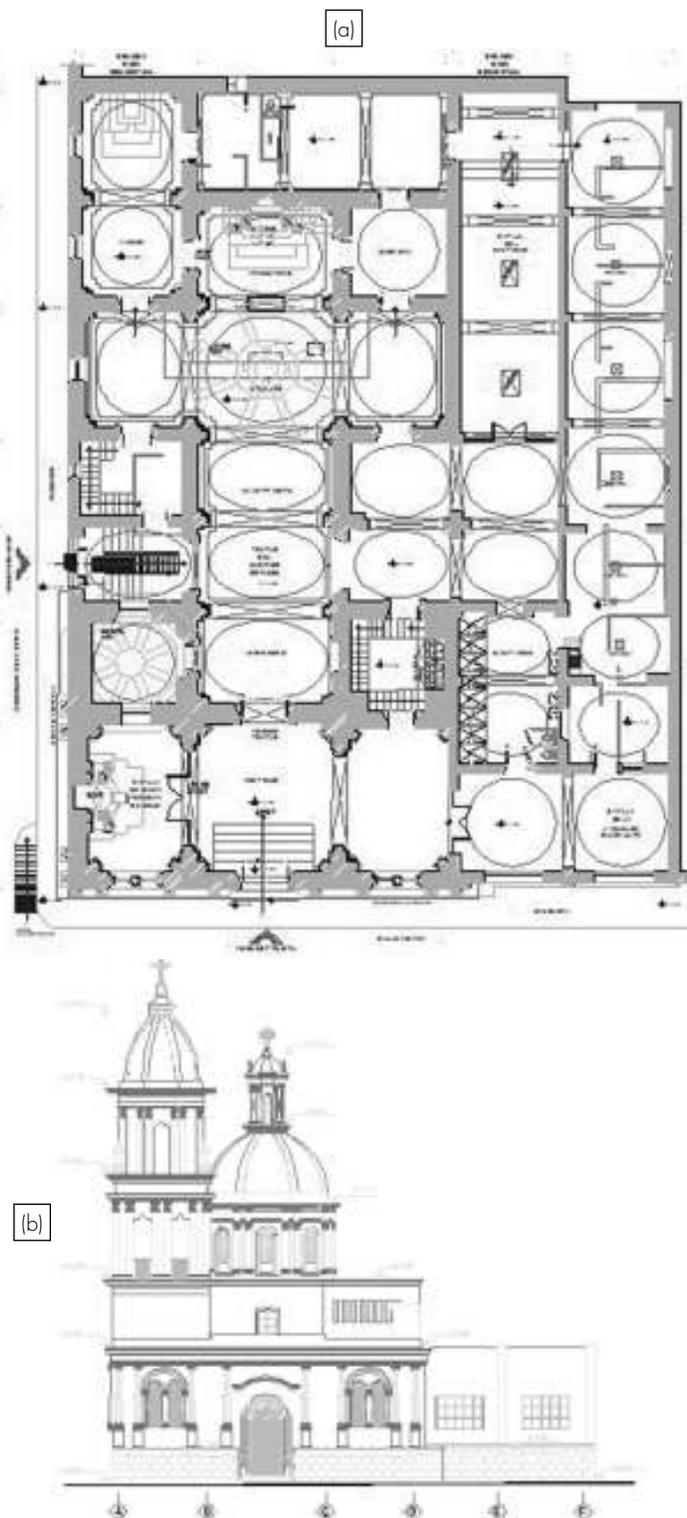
Levantamiento del templo del Sagrado Corazón. a) Planta arquitectónica. b) Alzado. Proyecto de Consolidación, Reestructuración y/o Reconstrucción del Templo del Sagrado Corazón en Colima, Colima, Conaculta-INAH, 2003.
